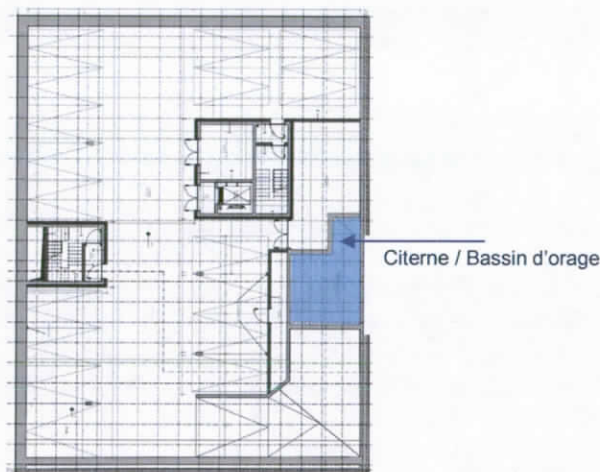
Plan du 2^{ème} sous-sol citerne et bassin d'orage (Source : AB 2018)
